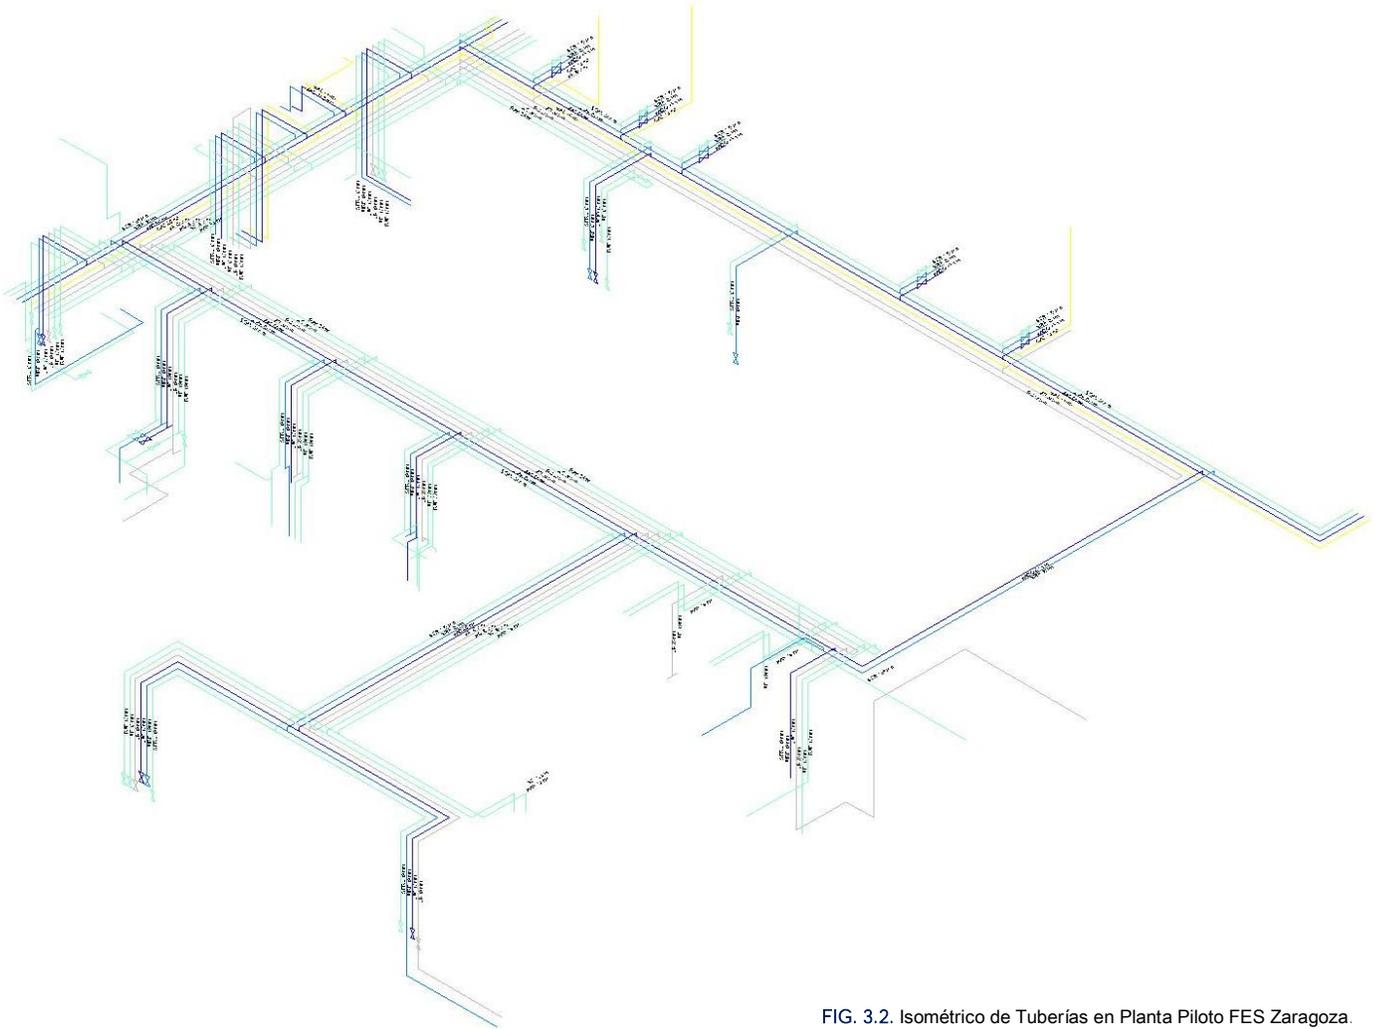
Isométrico de Tuberías en Planta Piloto FES Zaragoza.
